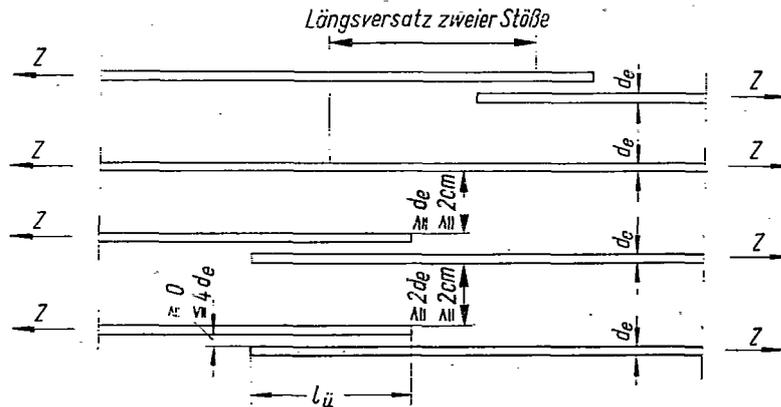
Abstand der Bewehrungsstäbe im Stoßbereich
